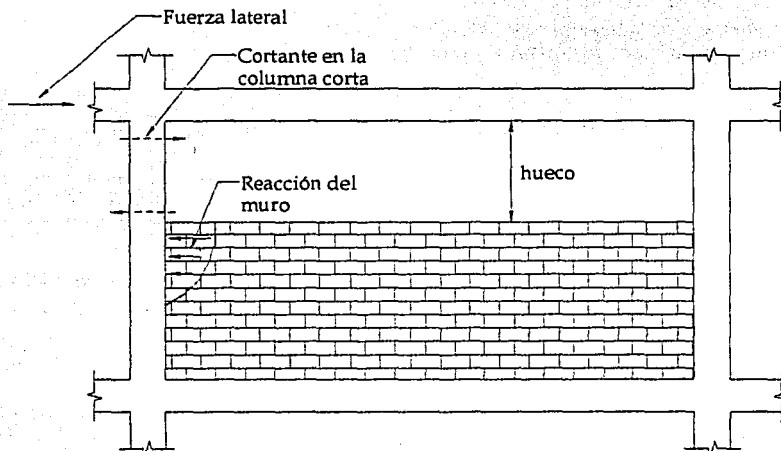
Efecto de columna corta en muro diafragma de altura incompleta.
